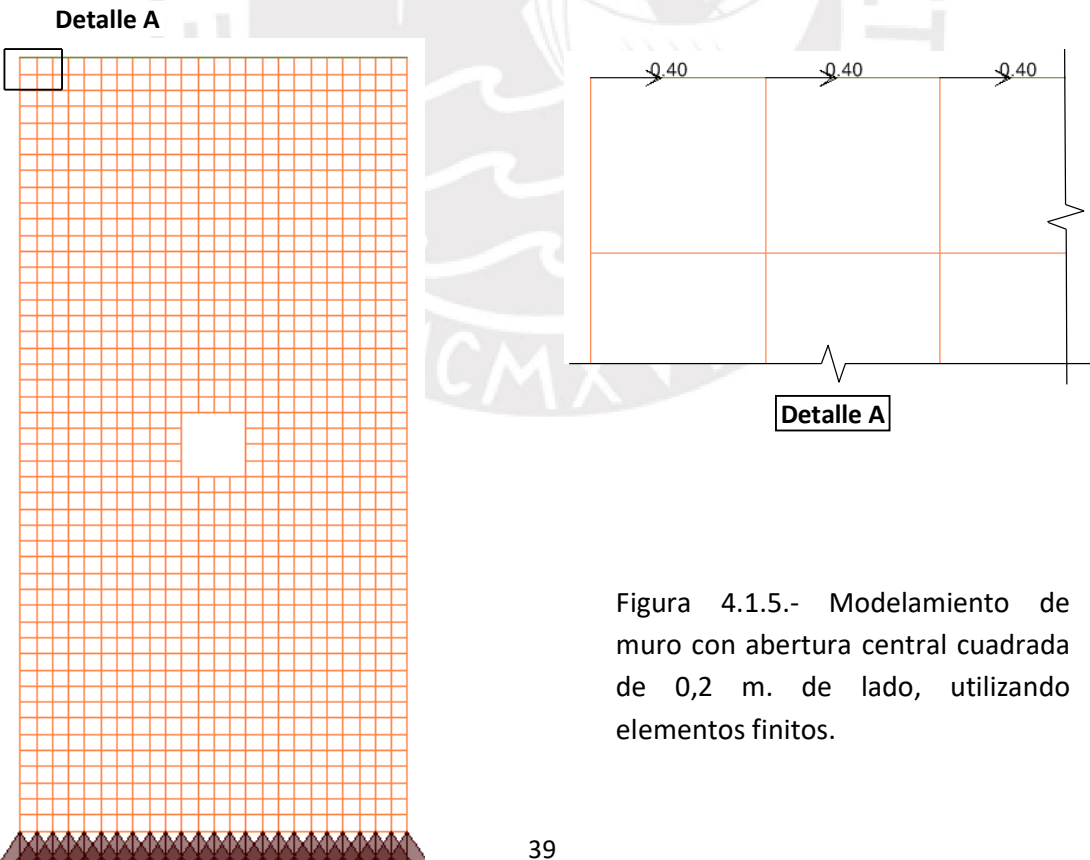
Modelamiento de muro con abertura central cuadrada de 0,2 m. de lado, utilizando elementos finitos.
